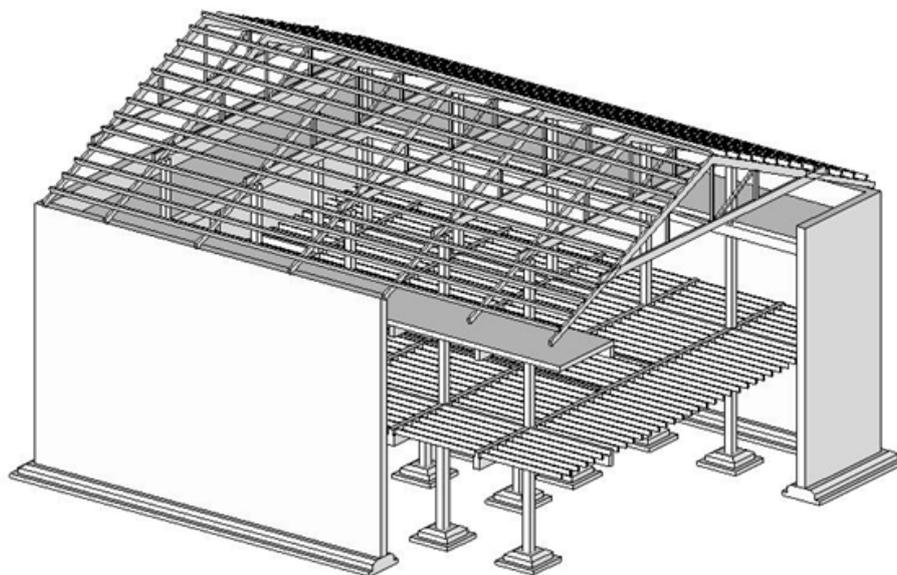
钢筋混凝土、砖墙、钢屋架混合结构体系示意图
